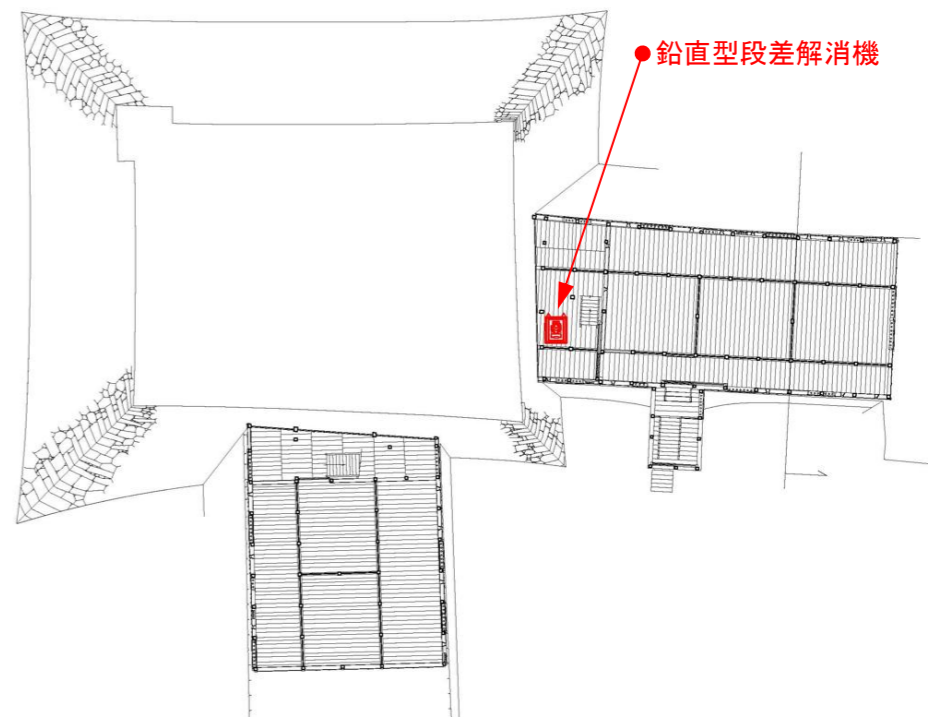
東廊下・南廊下 1 階平面図（復元原案）
